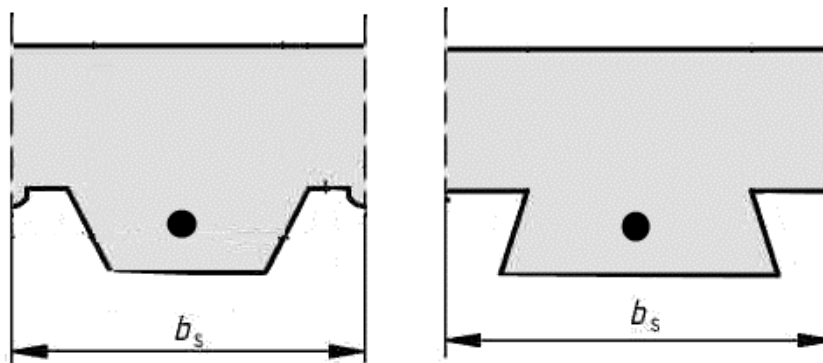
Расчетное сечение плит для случая вертикального сдвига
